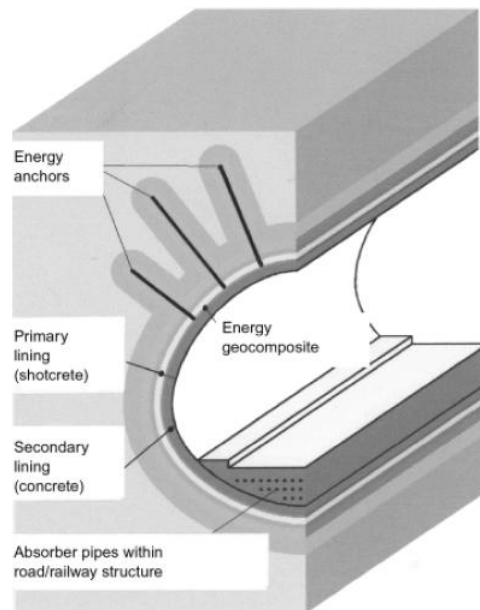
Tratto del Lainzer Tunnel realizzato con il New Austrian Tunnelling Method (NATM) (Brandl, 2006)
